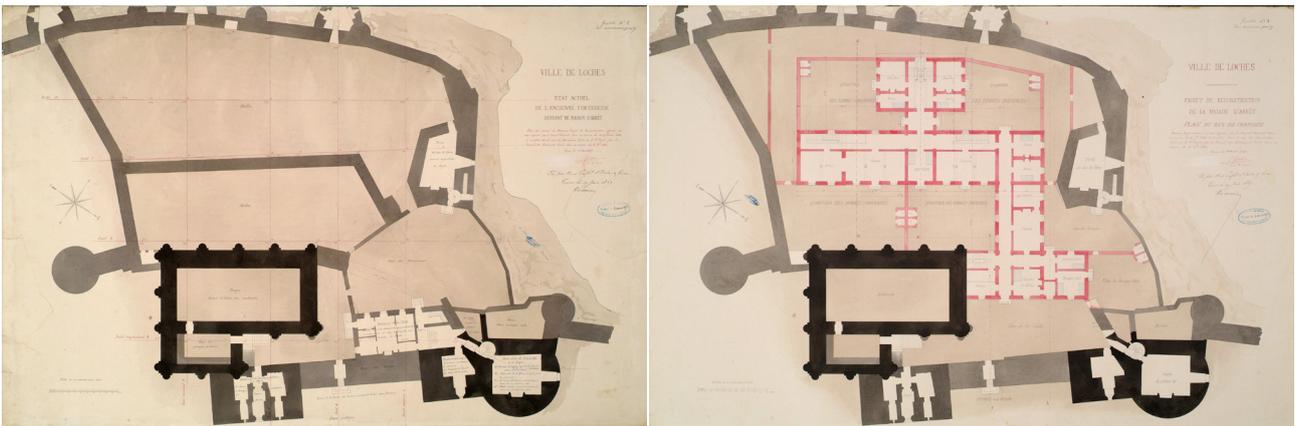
plan du projet de construction de nouvelles prisons de G. Guérin, 1856 (ADIL IV_31_3_5 et 6)
